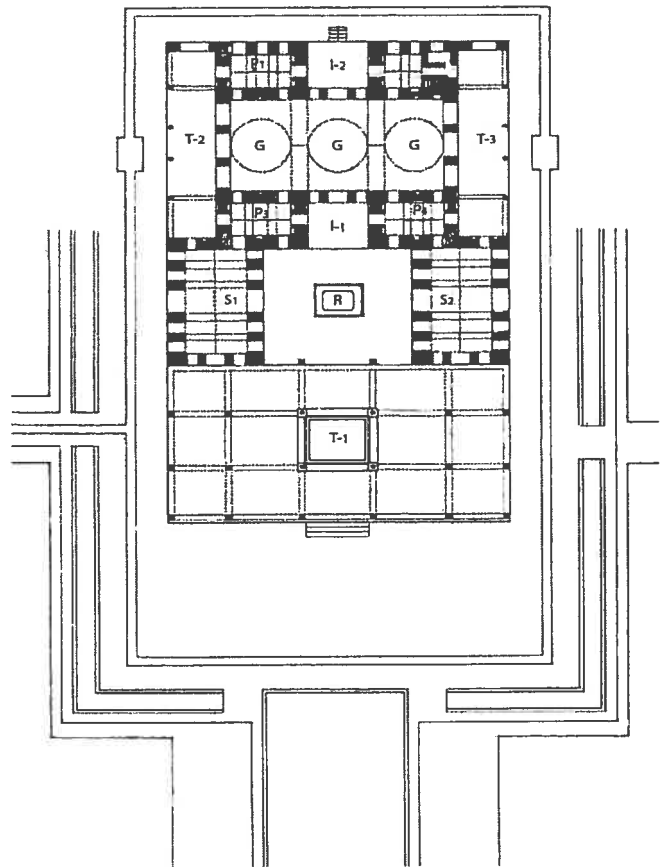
Plan du palais de Chehel Sotun d'après Ferrante, 1968
